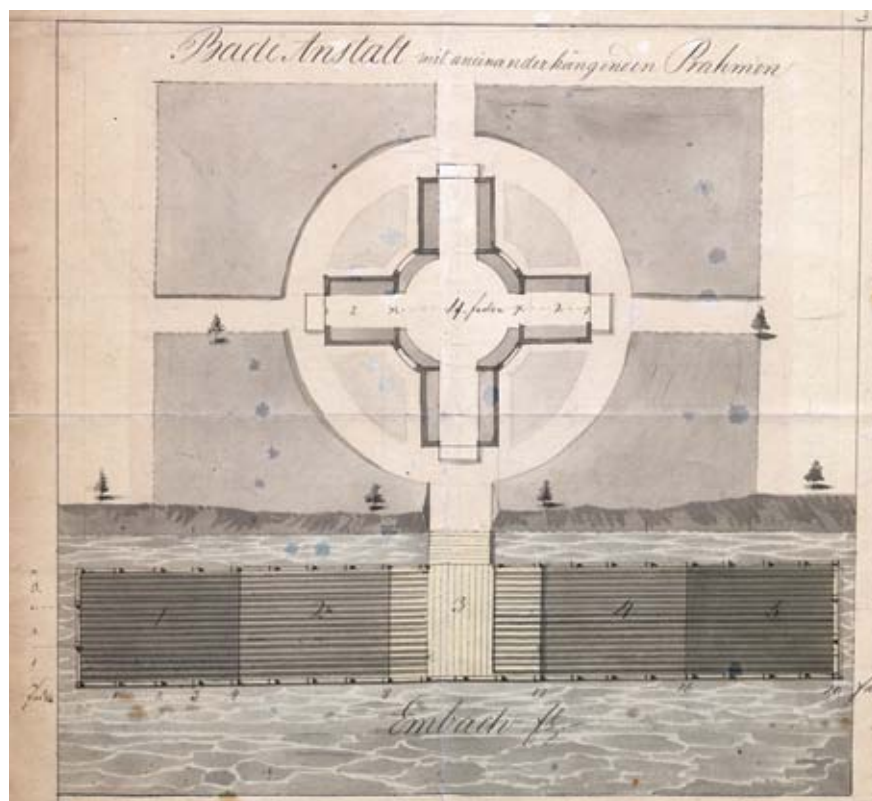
Johann Wilhelm Krause. Entwurf zu einem Badehaus in Dorpat im 18. Jahrhundert. Grundriss. Unbezeichnet. Vermutlich März 1805. Tartu, Universitätsbibliothek, 9-37-3.
